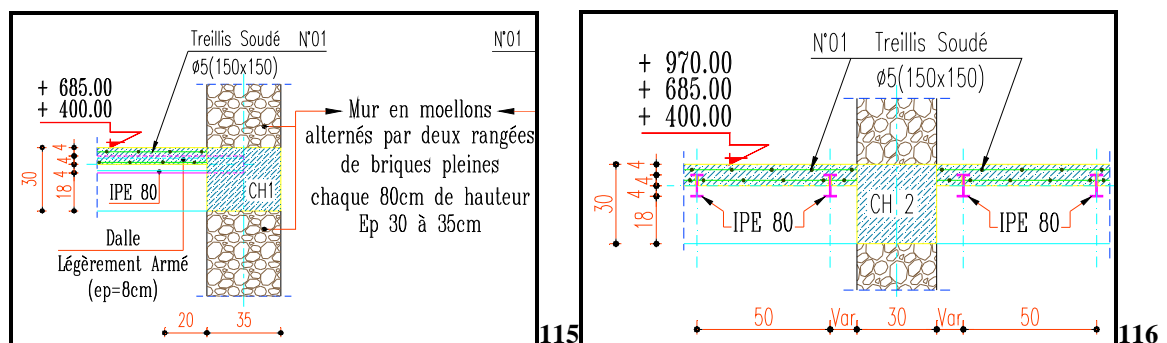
et : Systèmes de plancher de plancher au niveau de rive.
